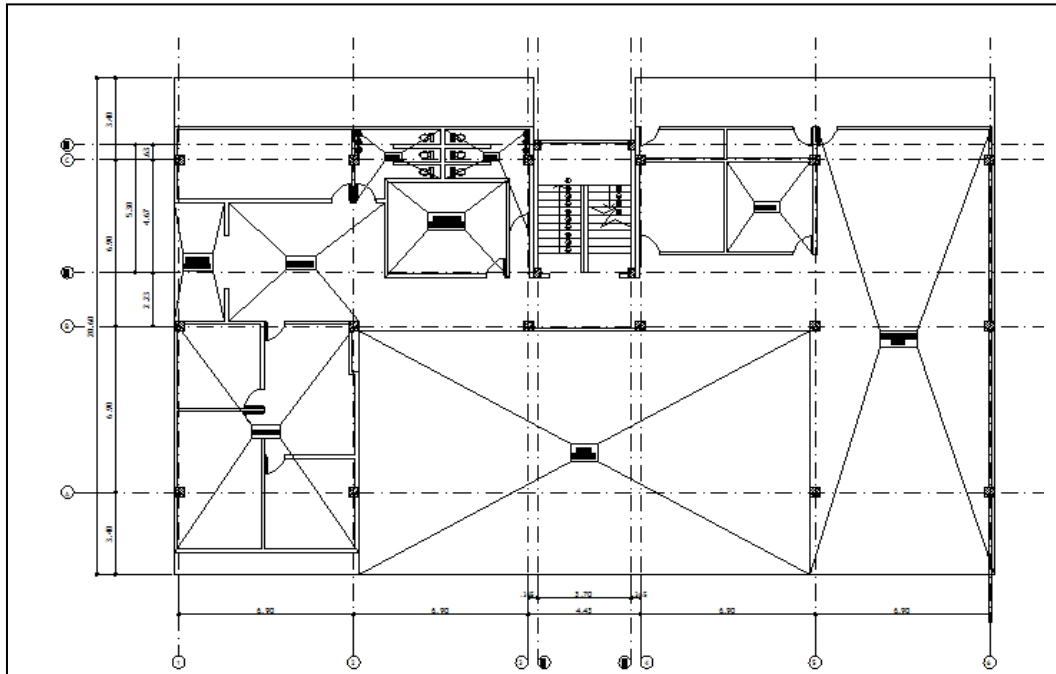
Nivel Planta Baja de la U. E. N. Padre Sojo. (Ver Anexo C)
